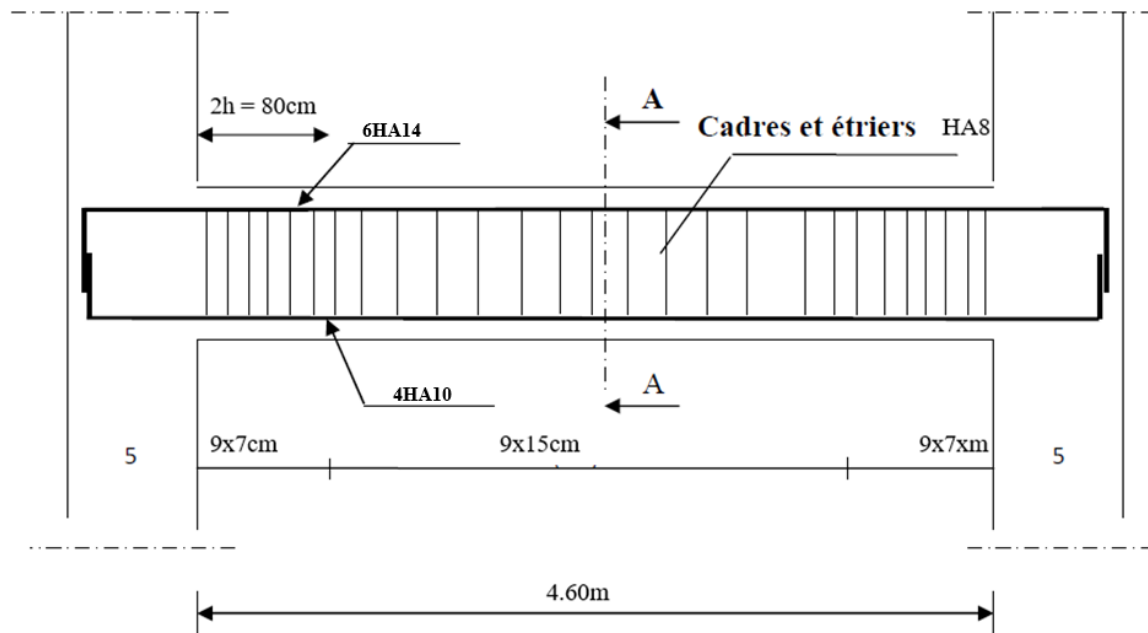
Schéma ferrailage de poutre palière
